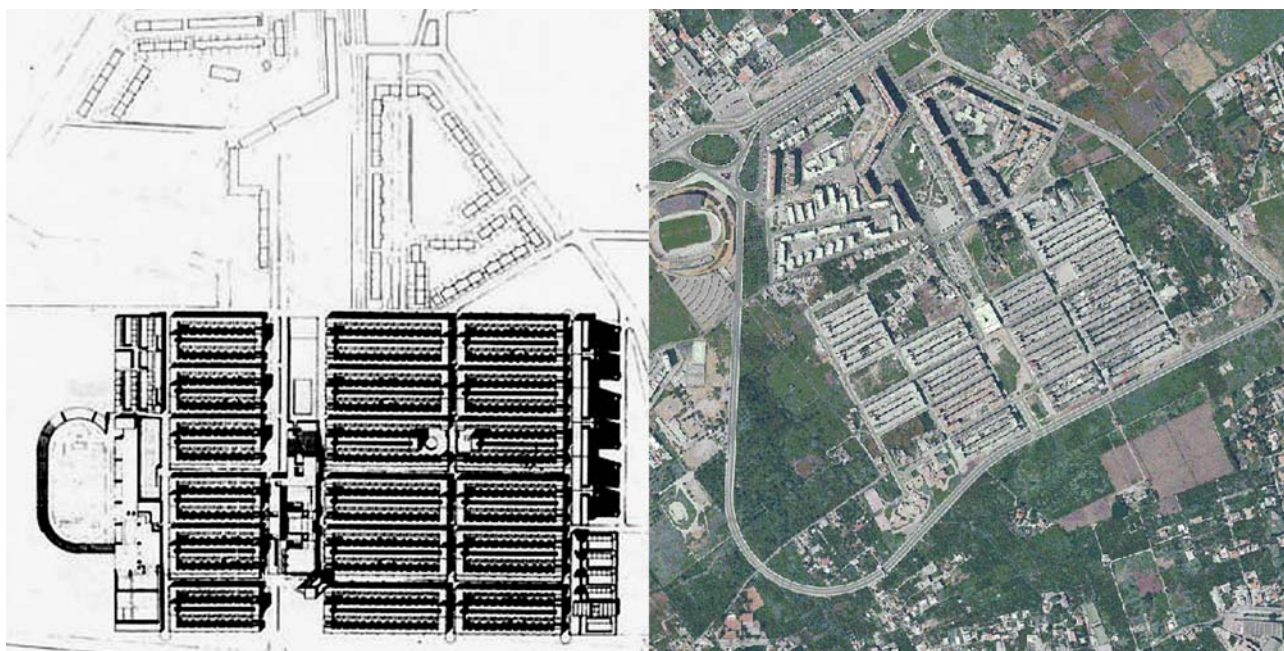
e 2 – Il progetto ZEN 2 del 1970 e lo stato attuale dell'intera area
